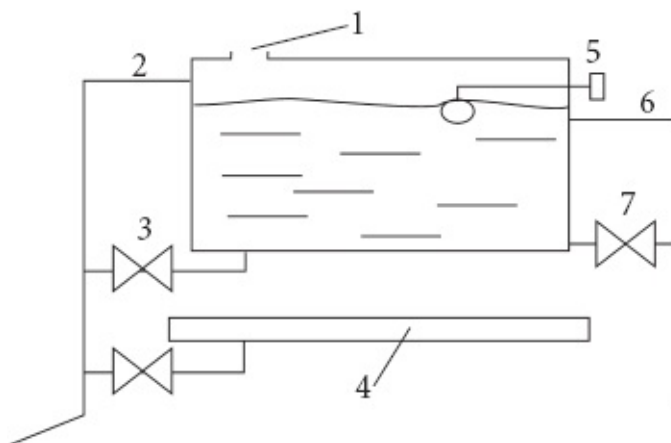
Водонапорный бак: 1 – отверстие для вентиляции; 2 – перелив; 3 – слив воды из бака и поддона; 4 – поддон; 5 – поплавковое реле для насоса; 6 – подача от насоса; 7 – расходный трубопровод
